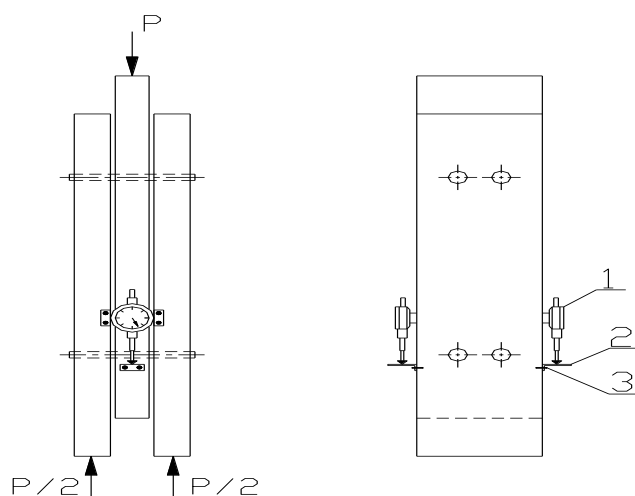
Схема загрузки образца и расстановки приборов:
